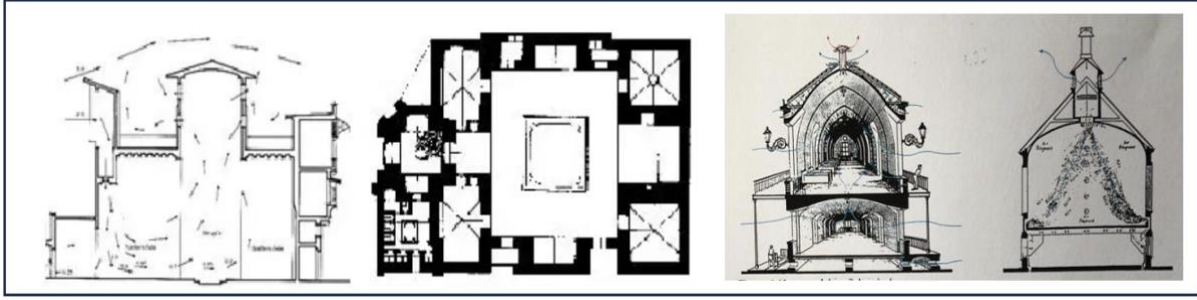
Villa Rotonda'nın Merkezindeki Havalandırma Boşluğunun Plan Ve Kesitte Görünümü, (Url-6).
